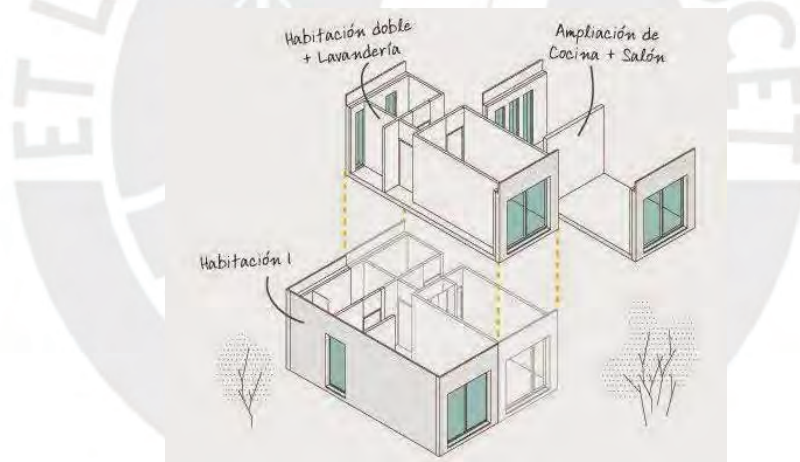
Vivienda modular tridimensional – APLIHORSA Modular
